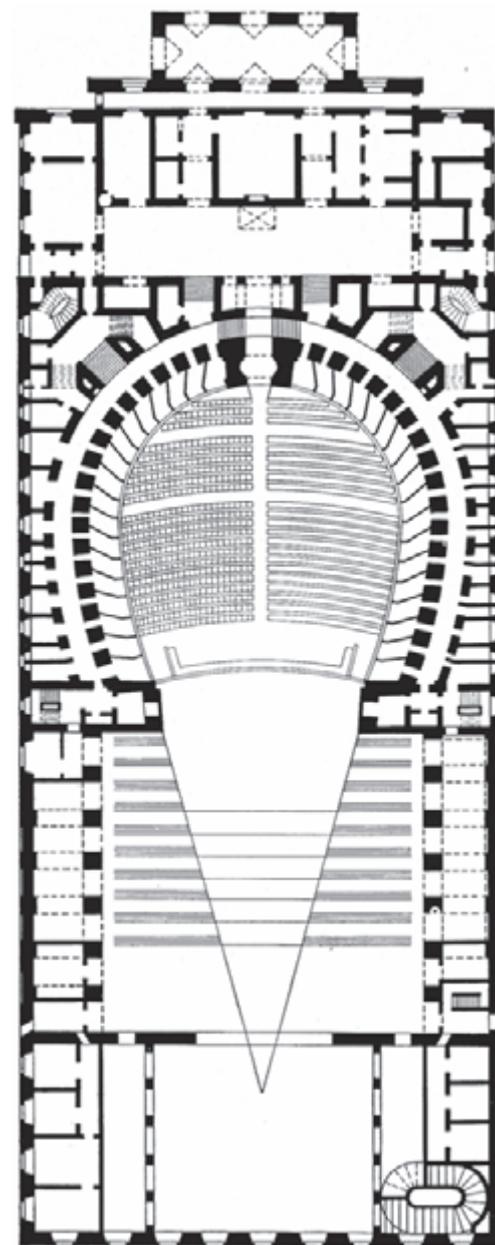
Giuseppe Piermarini, Teatro alla Scala, Milano, 1776-1778. Pianta.
